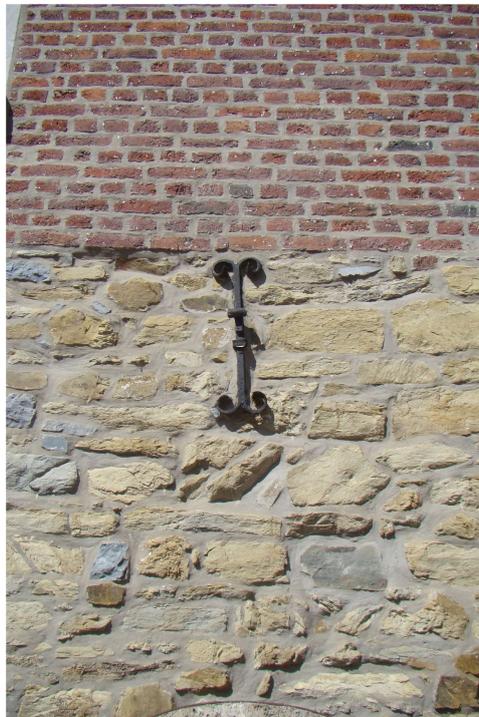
Photographie personnelle d'une ancre de mur façade Sud
